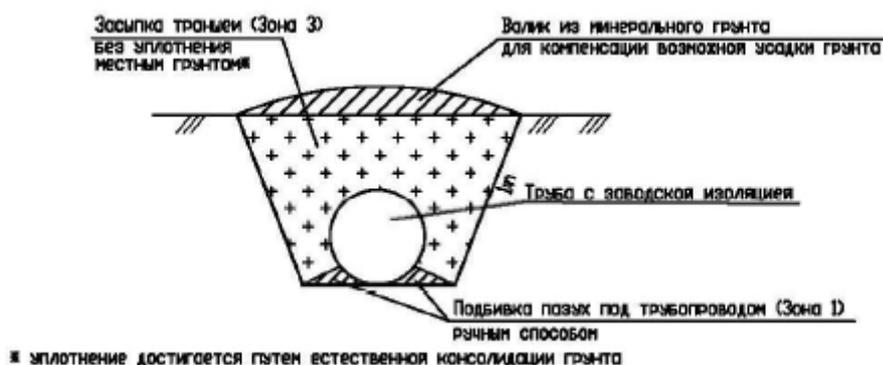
Схема уплотнения грунта обратной засыпки для трубопровода DN и менее с соотношением $t/D > 1/80$ (толстостенная труба) на землях, не относящихся к землям сельскохозяйственного назначения
